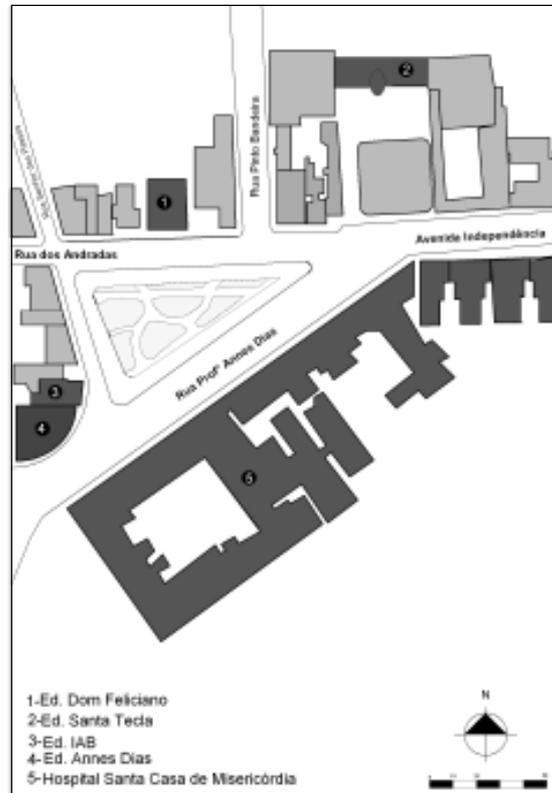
Planta de Situação da Praça Dom Feliciano.
